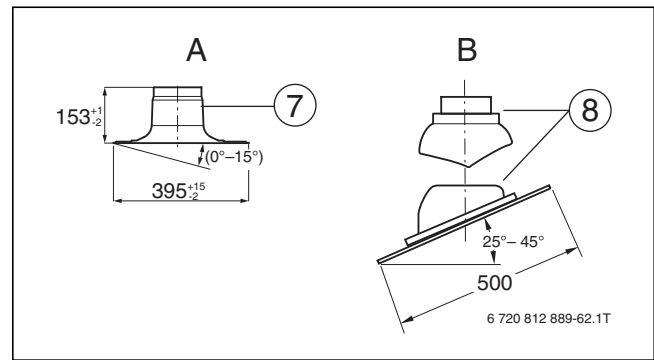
Universaldachpfannen und Flachdach-Klebeflansch als Zusatzausstattung für den Grundbausatz DO (unbedingt mitbestellen), (Maße in mm)
